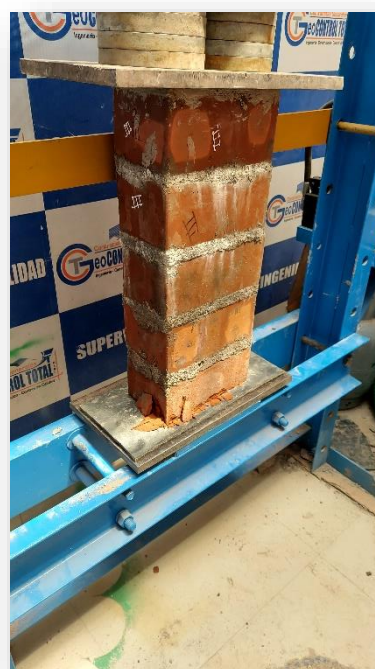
falla x compresión axial de pilas o prismas de albañilería
